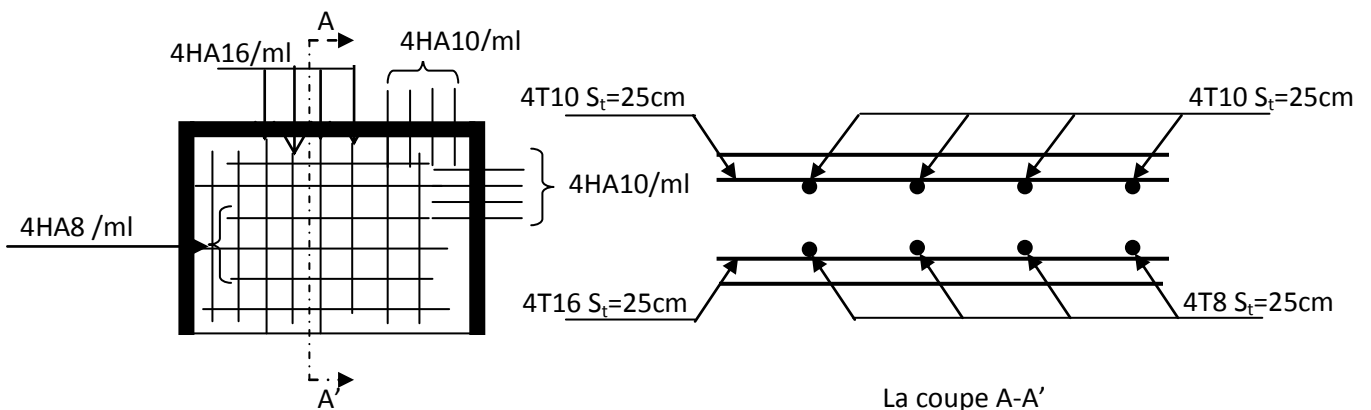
Schéma du ferrailage de la dalle pleine (cage d'escalier)
